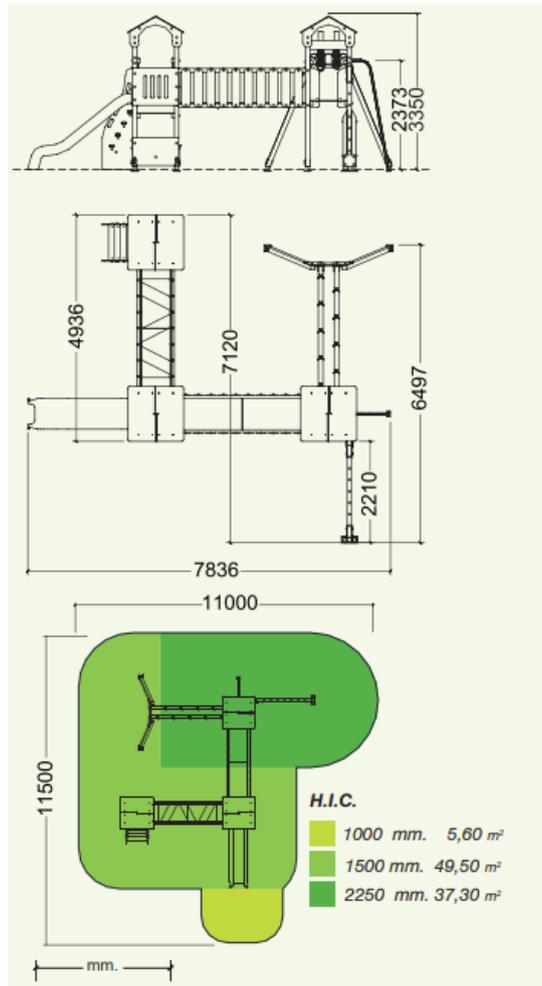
Dimensiones del conjunto de juegos infantiles instalado en el proyecto
